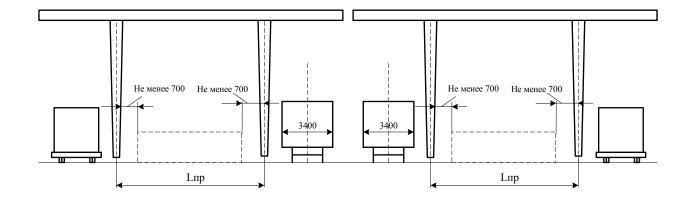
Поперечный разрез двухпролетного склада с козловыми кранами
